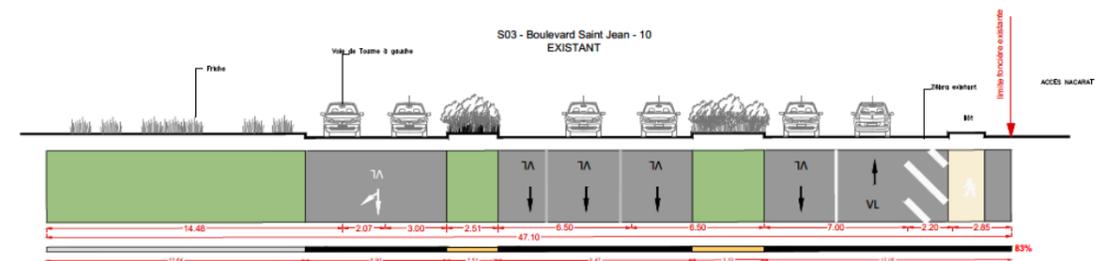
Profil existant du boulevard Saint-Jean au droit de la future ZAC
